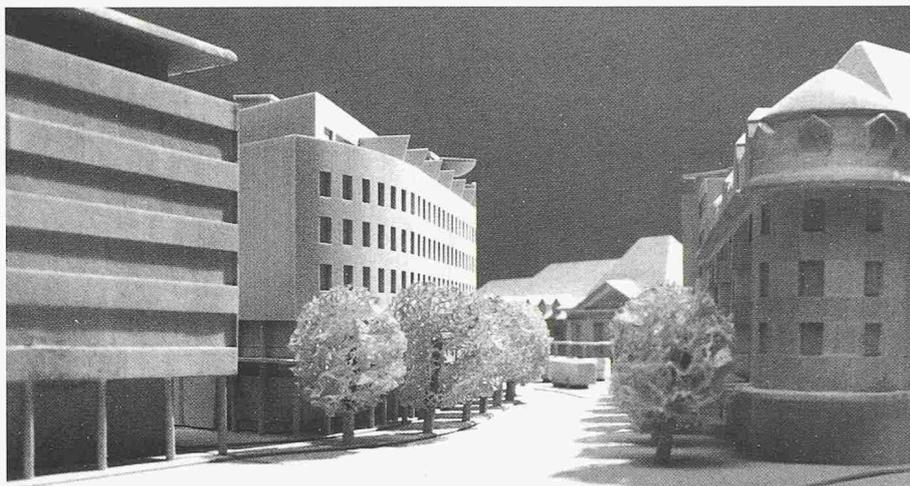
Bahnhofstrasse. Der neue Baukörper ergänzt, was lange schon geplant wurde. Die Achse zwischen Bahnhof und Schloss wird verdeutlicht
